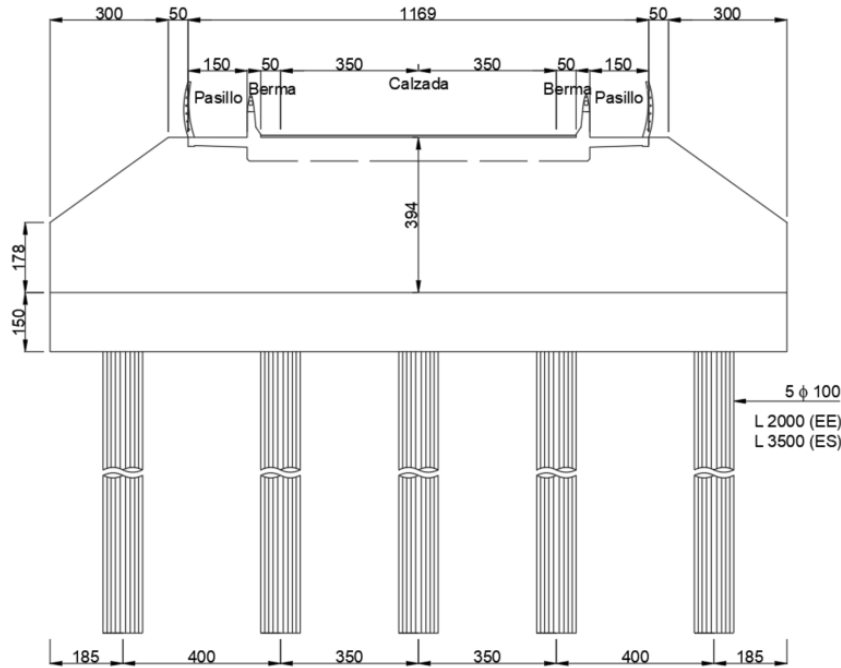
Estribos Puente 486-ES Laraquete (dimensiones en cm).
